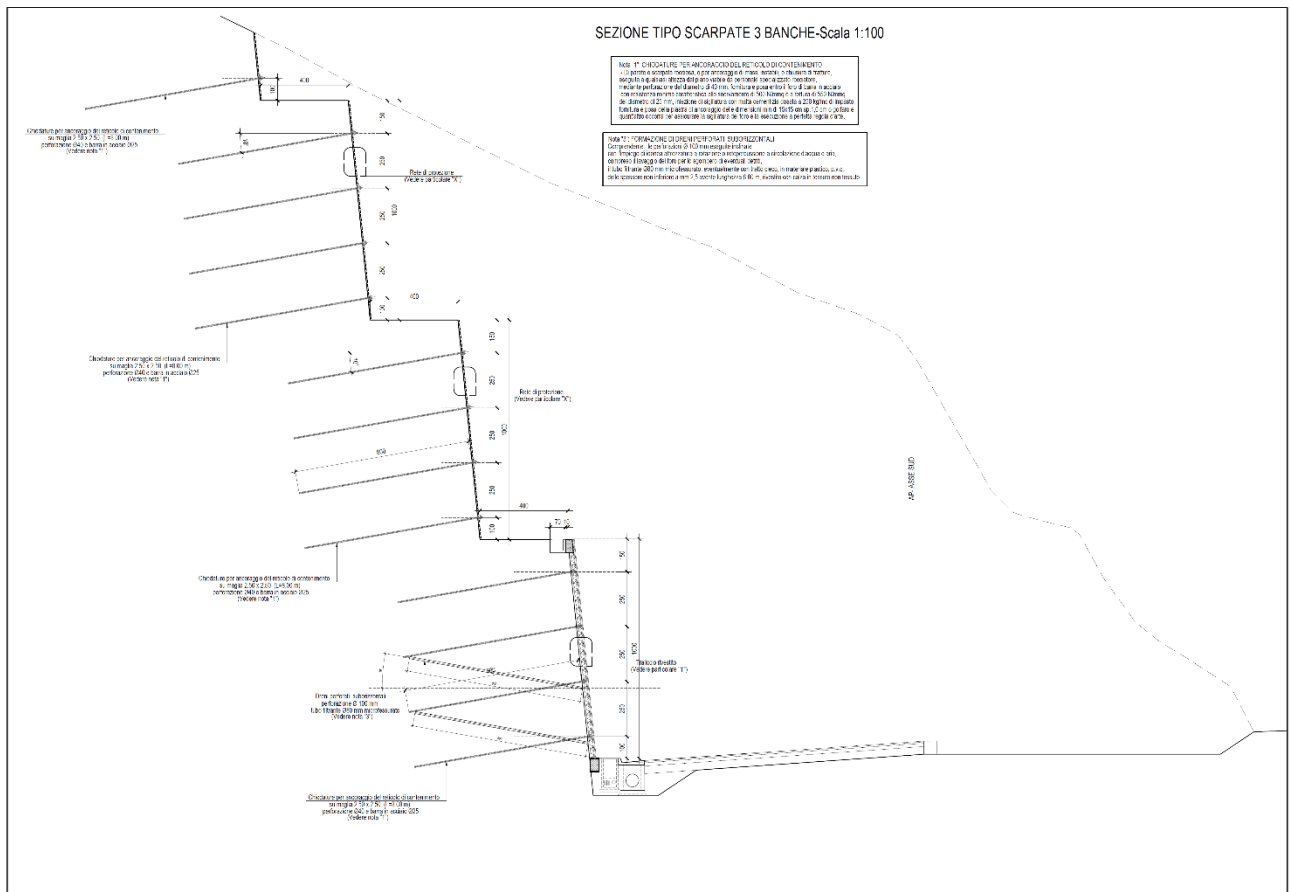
Lotto 1: sezione tipo scarpate 3 banche
